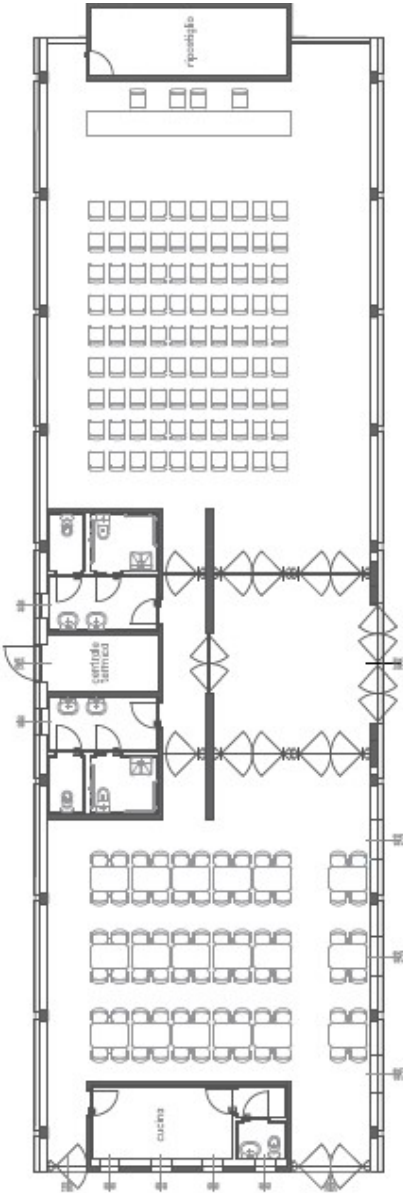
PLANIMETRIA PIANO TERRA MENSA
